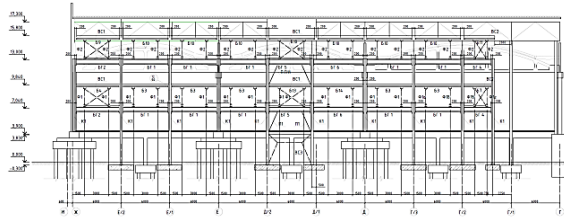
Расположение колонн, несущих балок и ферм перекрытий дополнительных этажей по оси 11.
